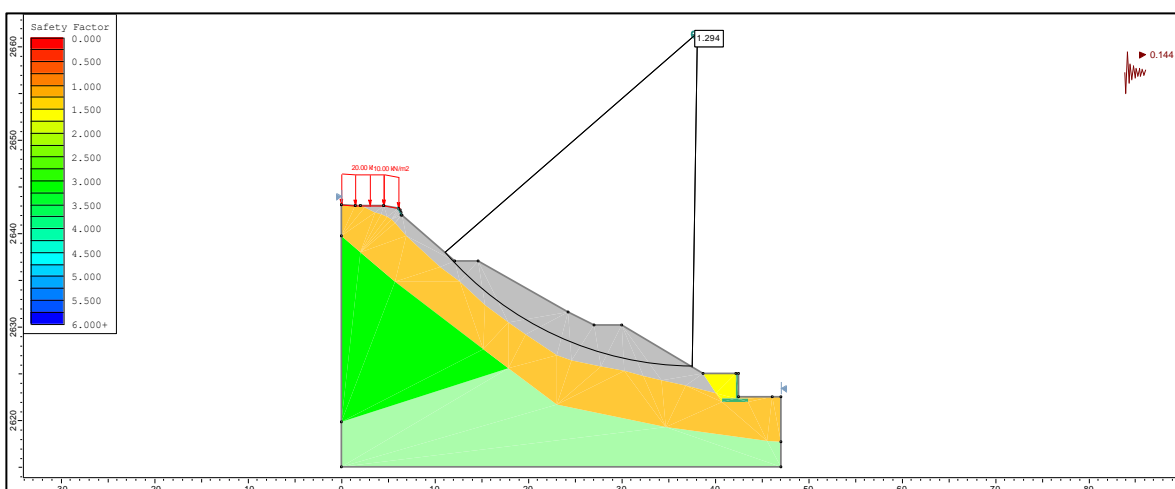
Sección 4-4' con obras Alt. 2 condición pseudoestática y con drenaje $ru=0.1$
